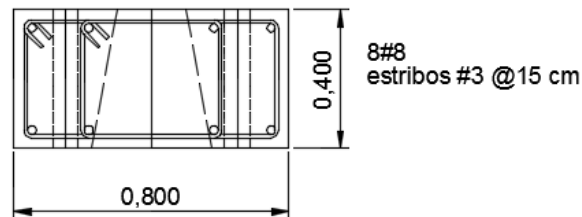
Características del armado de la dala de cimentación (Jaen, 2015).
